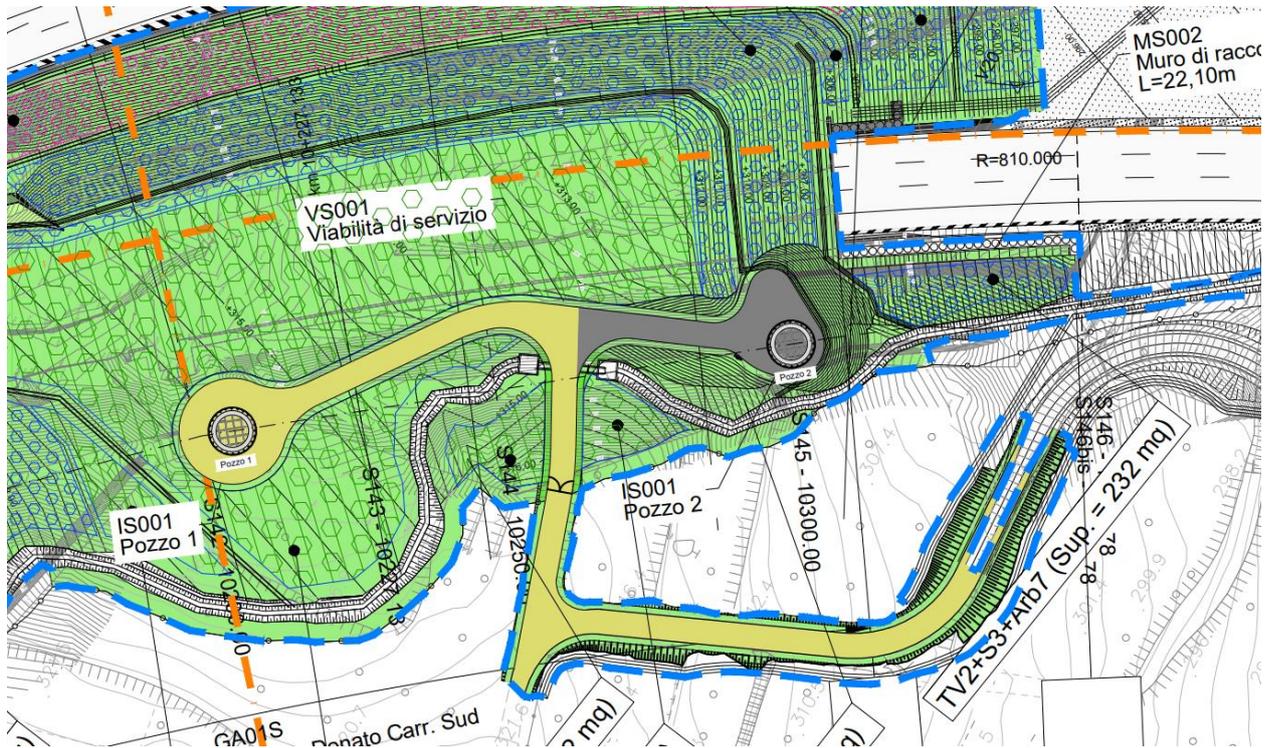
Planimetria di sistemazione definitiva: in ocra la pavimentazione permeabile con pendenze più dolci in misto granulare; in grigio la pavimentazione impermeabile a finitura bituminosa col piazzale di manovra per l'accesso al pozzo 2.
